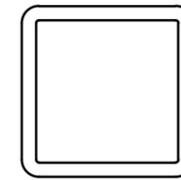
SOUS-PLANCHER DE 25 mm X 25 mm EN ALUMINIUM OU ACIER
